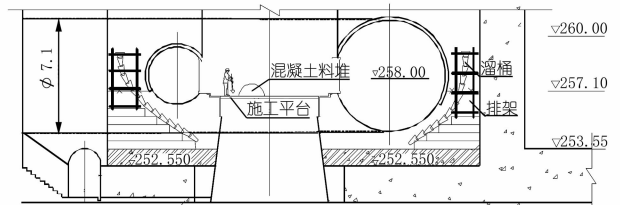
蜗壳底部二期混凝土浇筑示意(单位:m)
